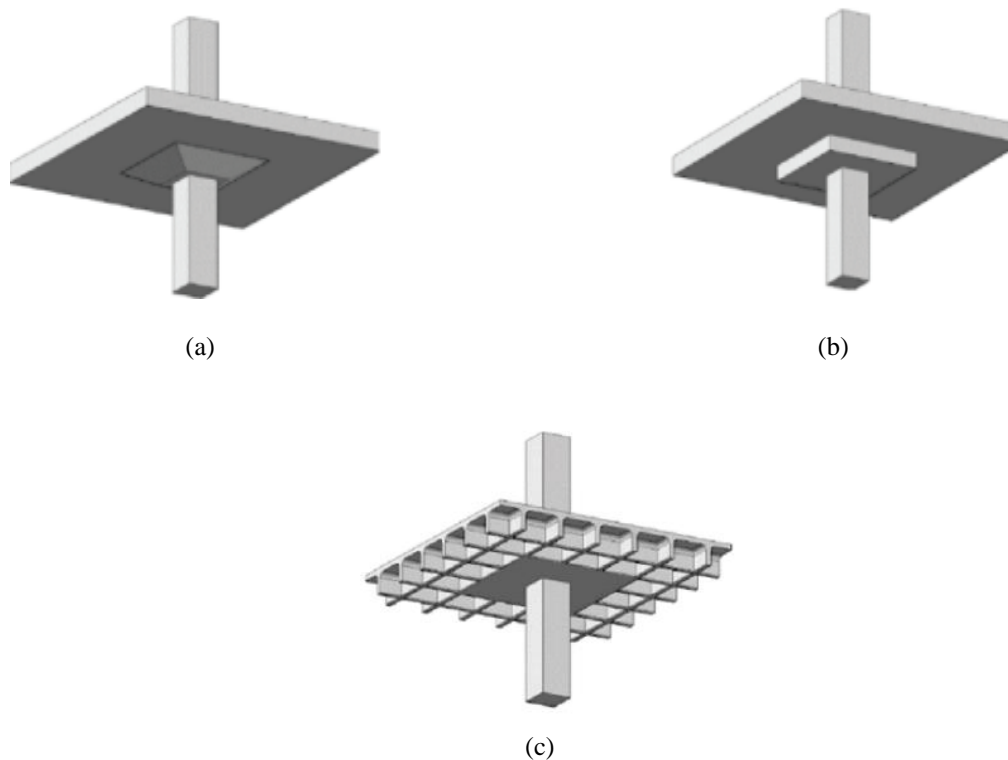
(a) Laje cogumelo com capitel. (b) Laje cogumelo com capitel. (c) Laje lisa nervurada.
